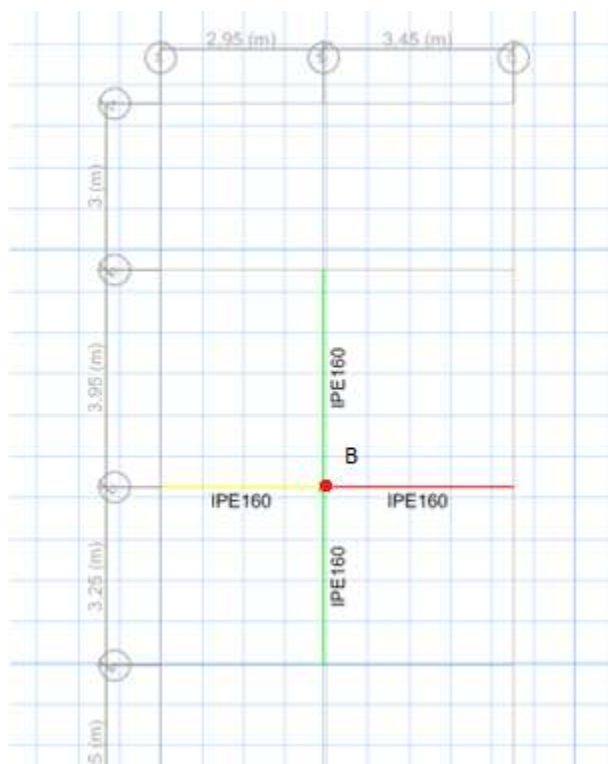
LONGITUDES DE LAS VIGAS EN EL PUNTO B
